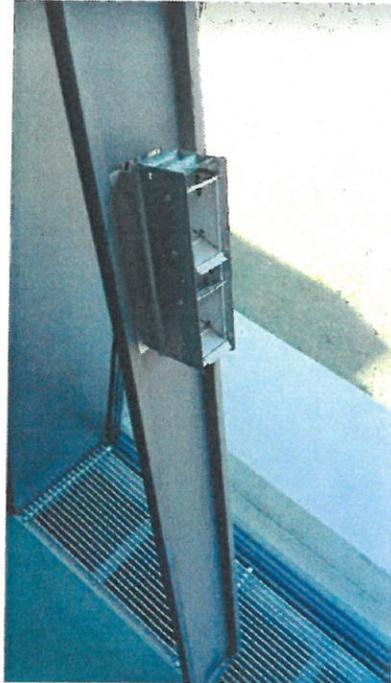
Vista dell'elemento di chiusura inferiore del canale di ventilazione negli uffici
